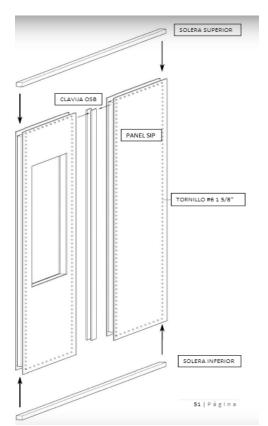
Esquema colocación de paneles SIP para vivienda de emergencia ONEMI.
